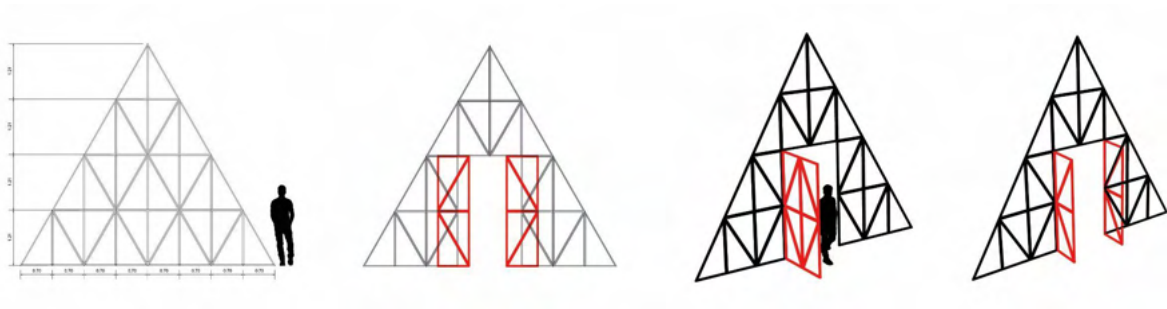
Primeiros estudos da fachada norte e do sistema de abertura da porta. (Joseph Caires). (2022).
